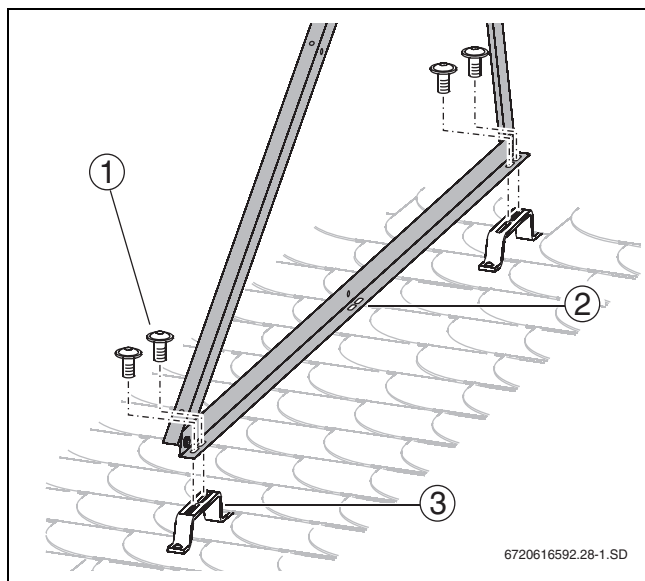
Крепление специальными кровельными крюками (здесь: на покрытие шифером/ гонтом)
